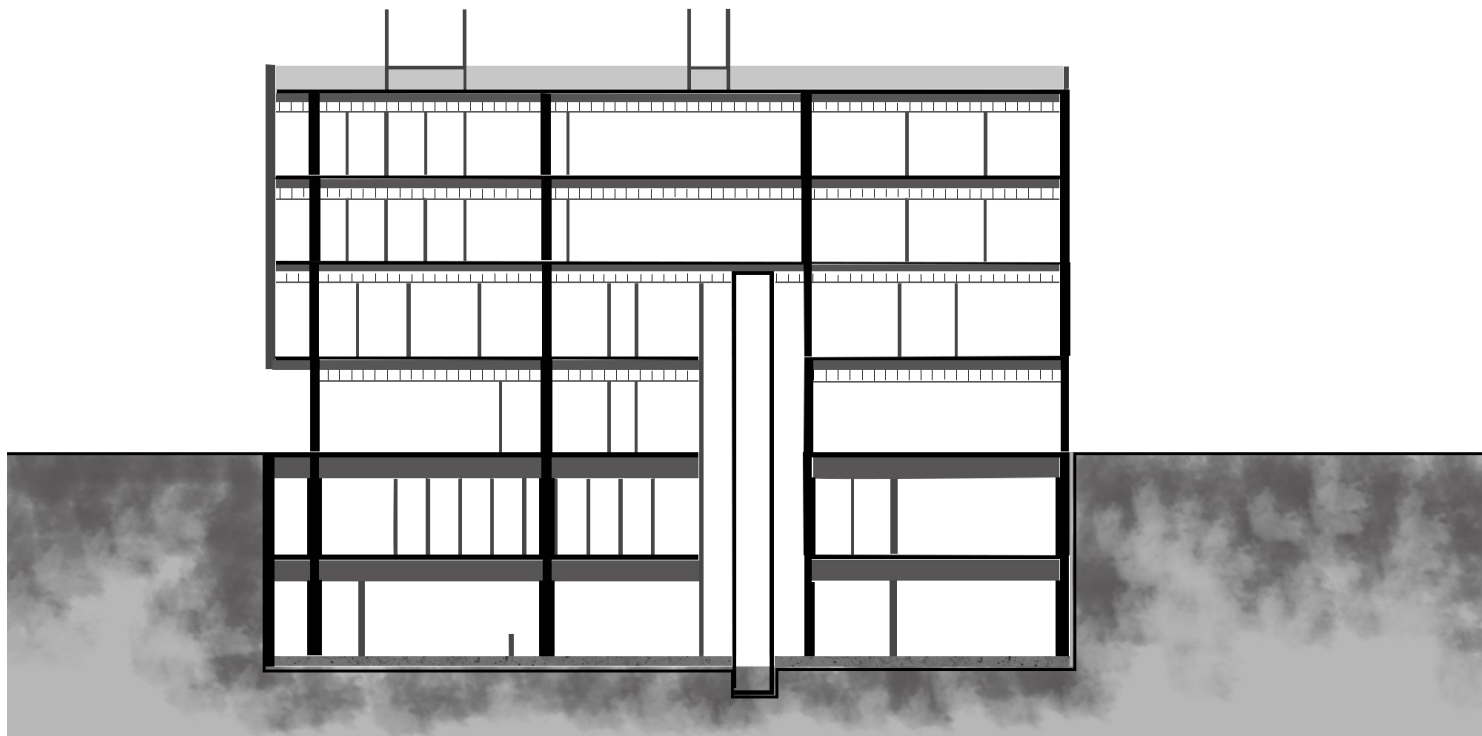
Corte arquitectónico del edificio. Elaboración propia.
